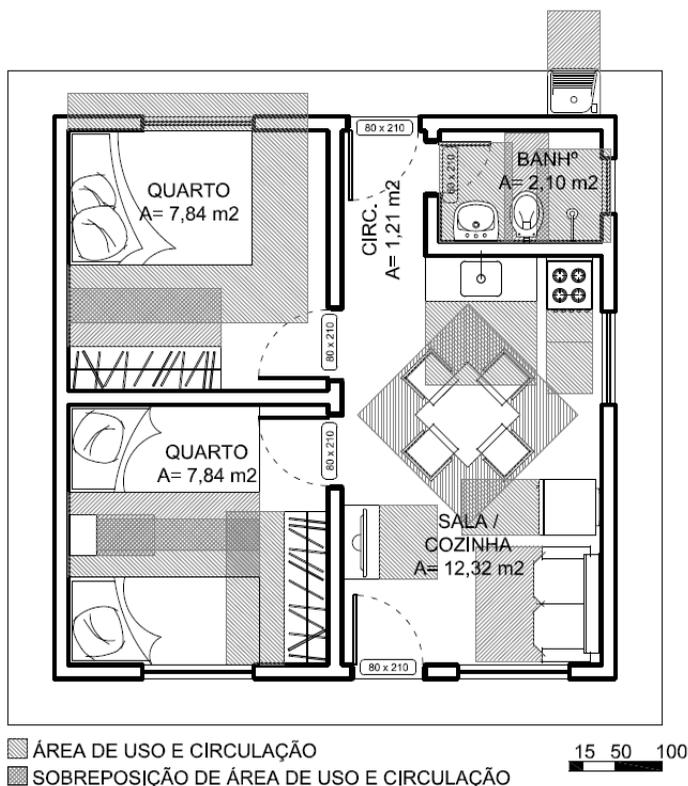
Conjunto 1 – Planta baixa da UH tipo 1.
